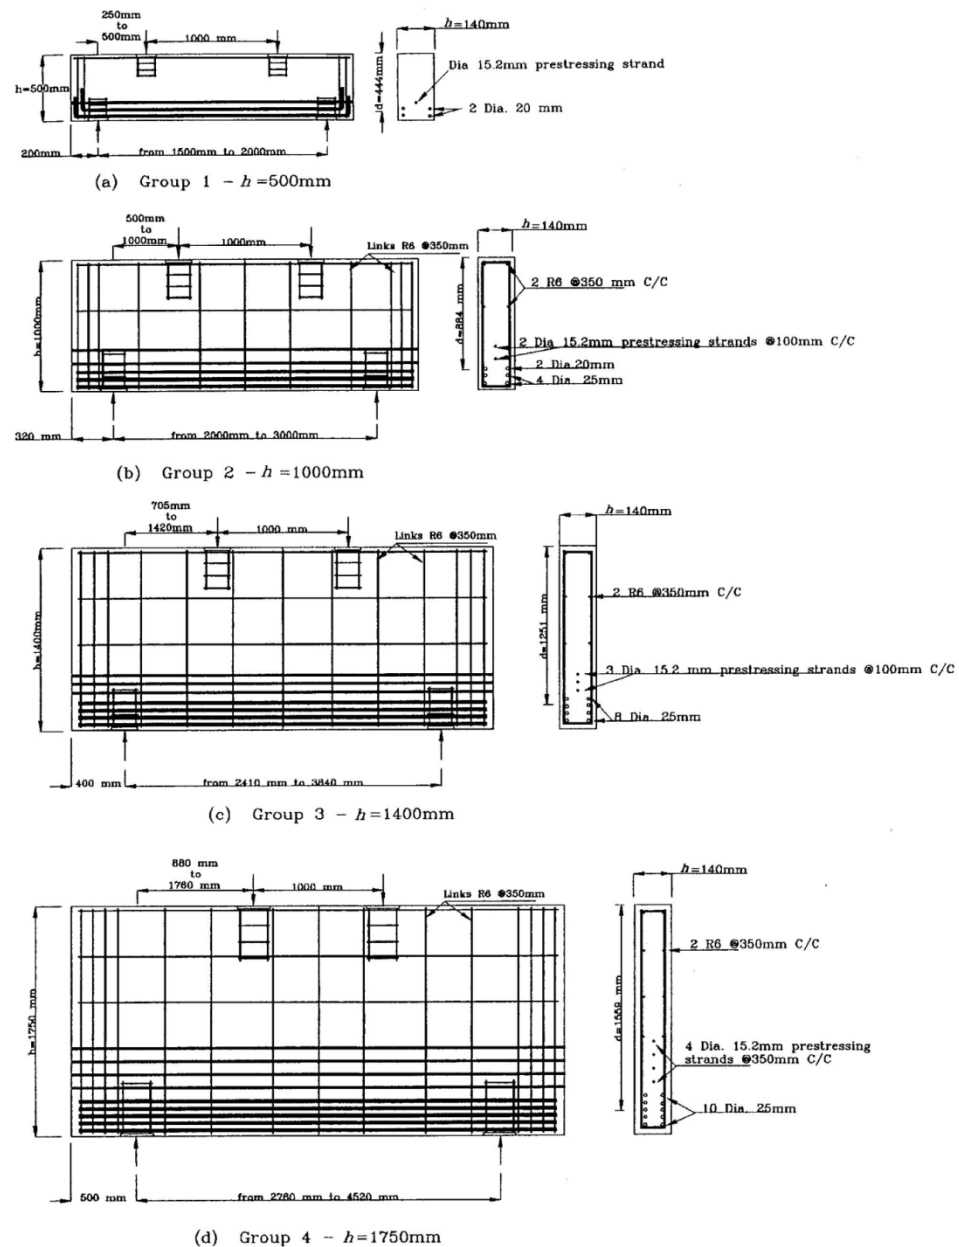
Detalhamento das vigas-paredes ensaiadas por TAN et al (1999)
